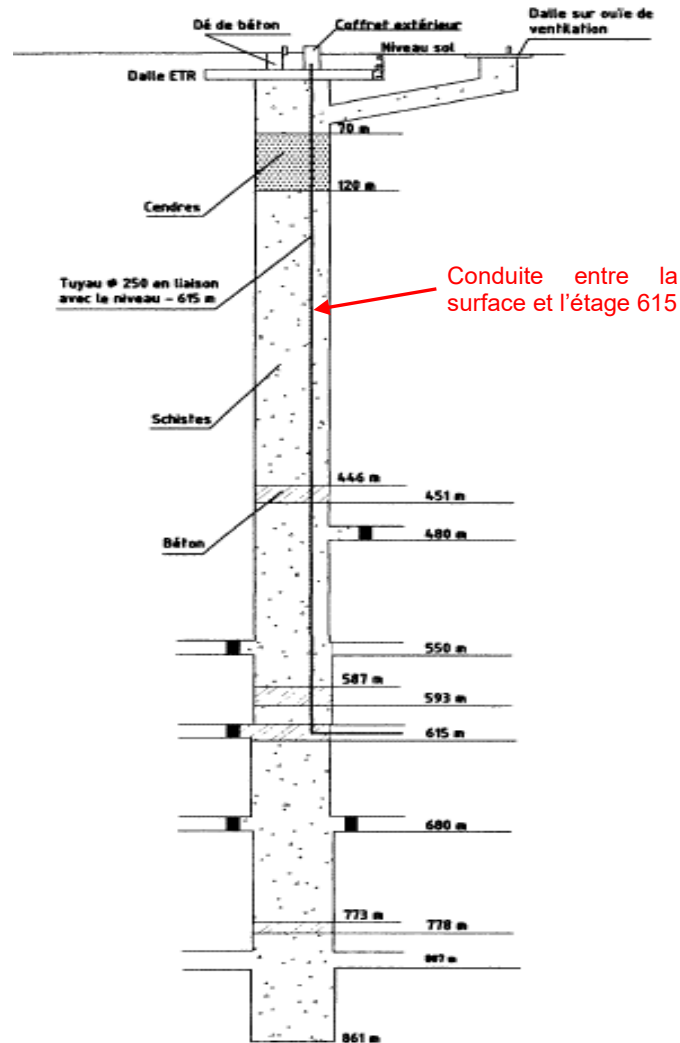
Puits 6bis de Liévin – schéma de la conduite à l'étage 615 (source : BRGM)
